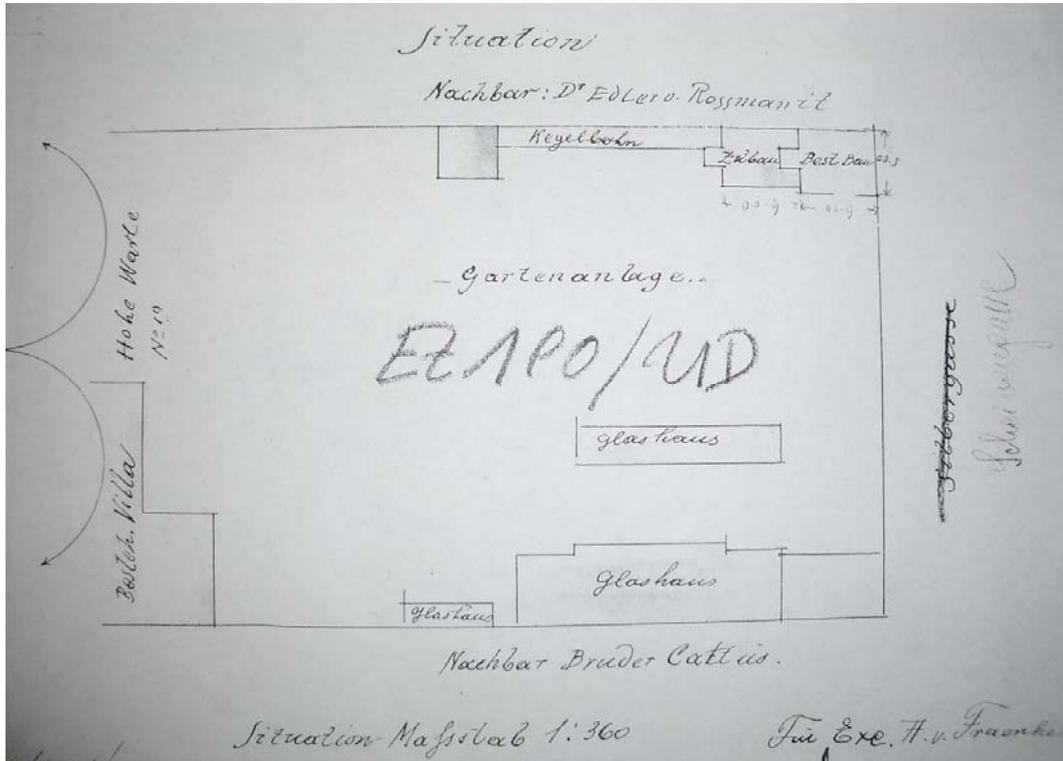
Villa Rittershausen. Situationsplan. 1914. Einreichplan.
